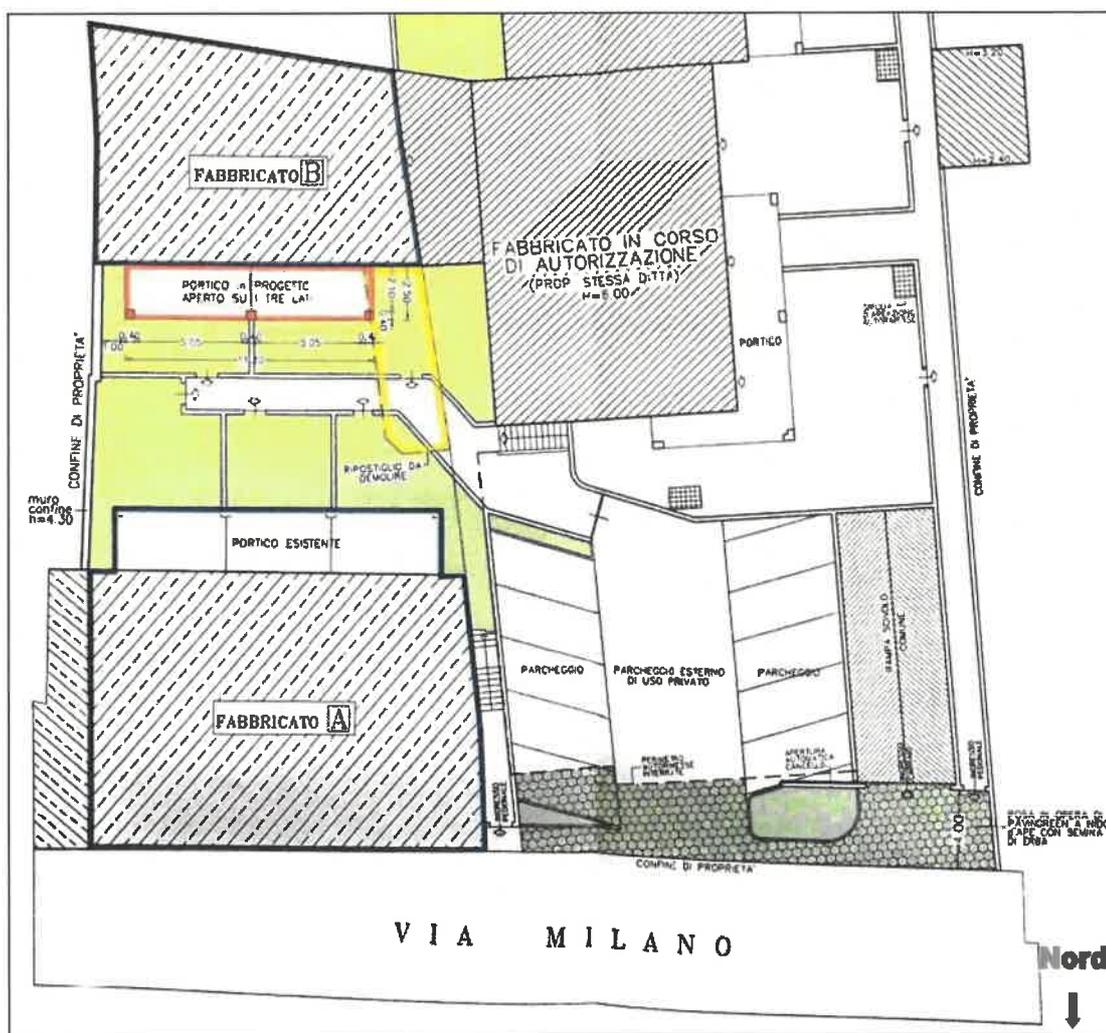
planimetria generale del complesso edilizio dell'ultima autorizzazione edilizia
